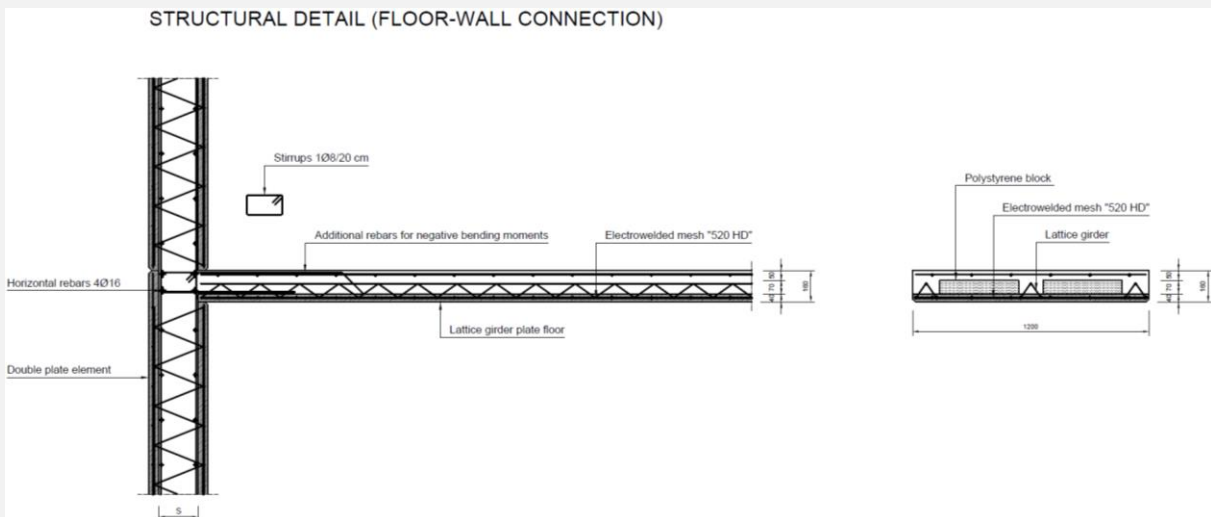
Detaliu structural tipic pentru îmbinarea dintre peretele din b.a. și planșeul din b.a. prefabricat (secțiune verticală).
